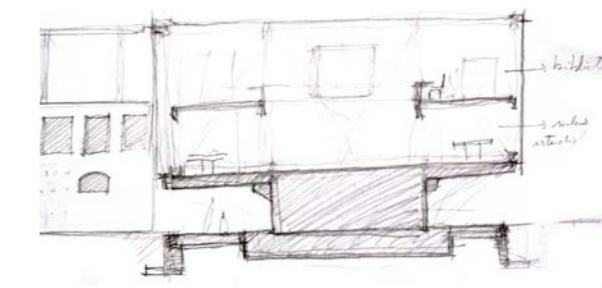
Planta estado de avance, propuesta edificio biblioteca.
